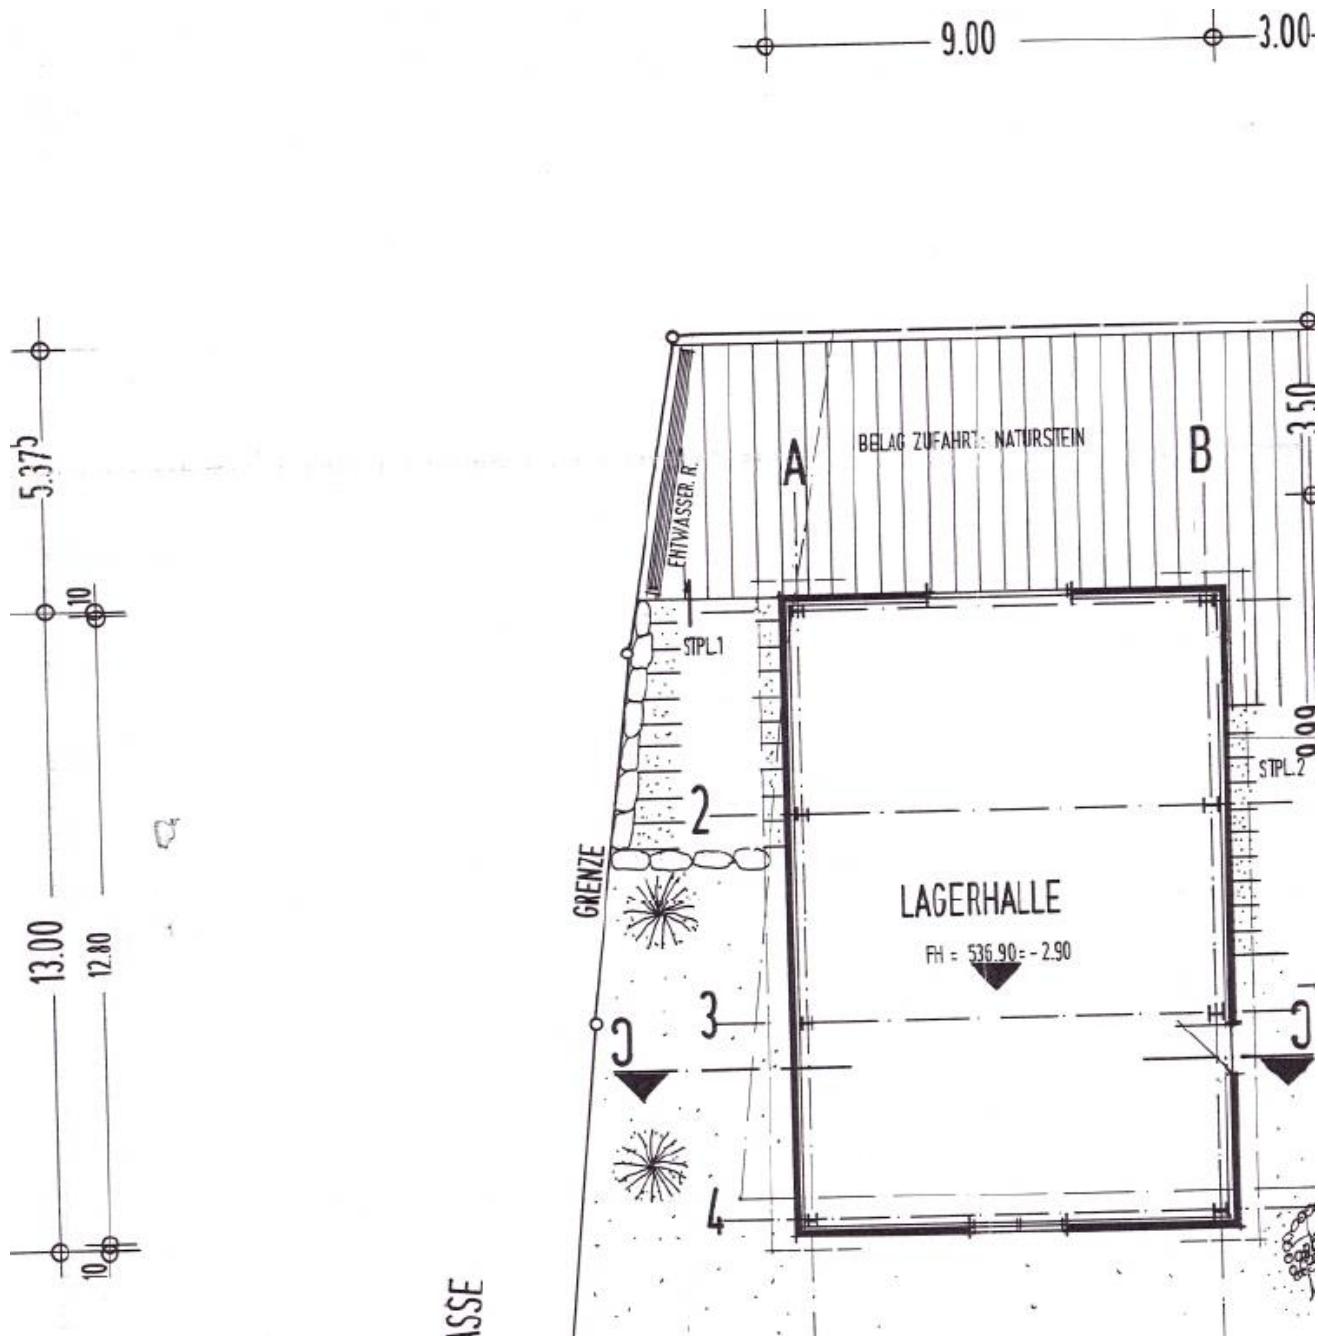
Grundriss Erdgeschoss Lagerhalle (ohne Maßstab) ohne Außenüberdachung; Quelle: Bauakte, Baugesuch von 1999
